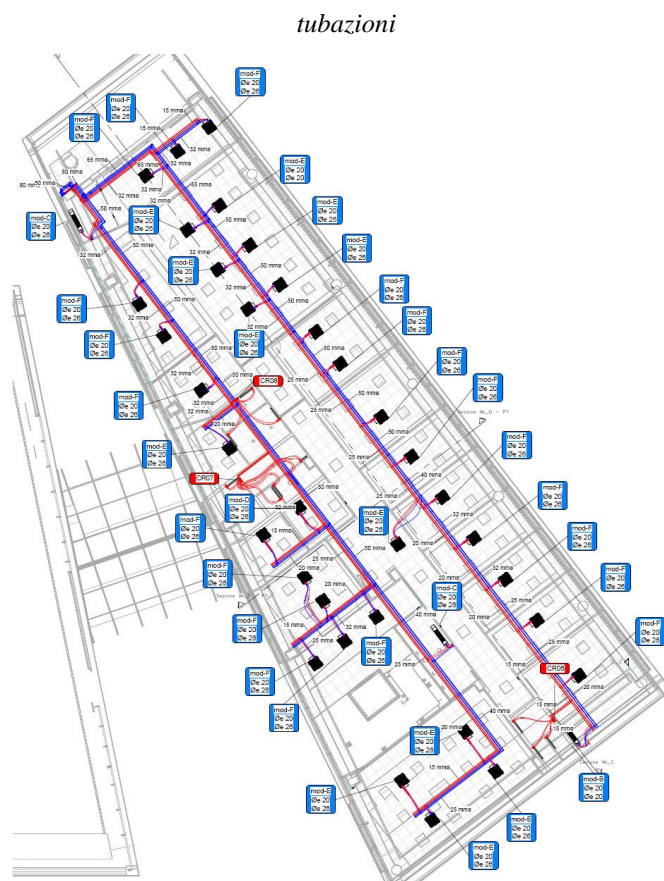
PCC Piano Primo : impianto climatizzazione, posizione ventilconvettori e passaggio delle tubazioni
